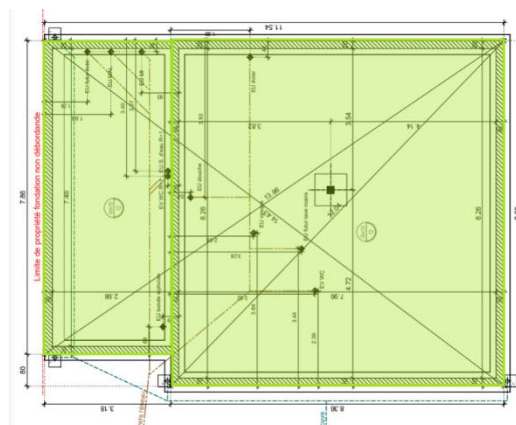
Plan de fondation – Dallage sur terre-plein.
